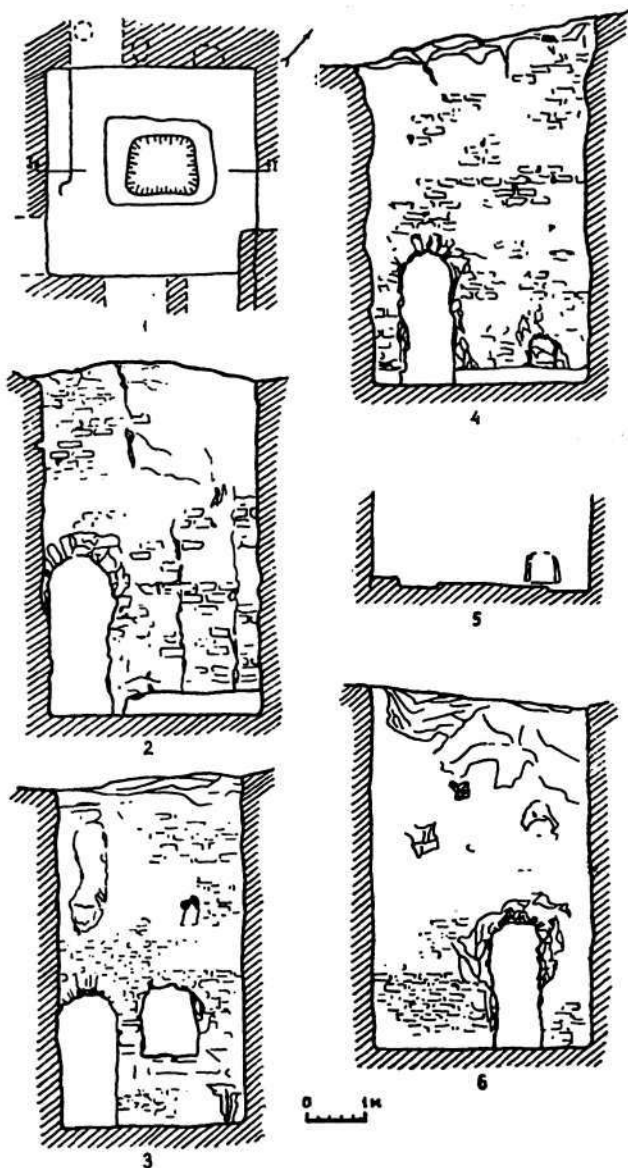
Помещение 6. 1 — план; 2 — фасад западной стены; 3 — фасад южной стены; 4 — фасад северной стены; 5 — разрез I—I по верхнему полу; 6 — фасад восточной стены.
